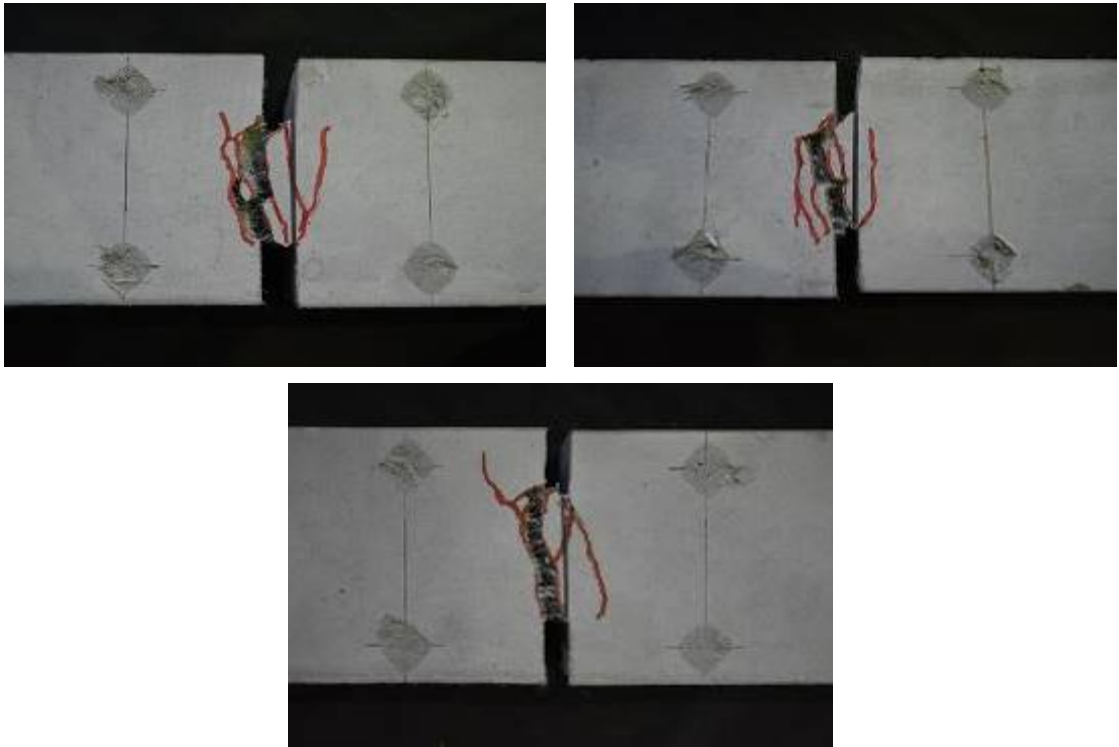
ひび割れ状況（切欠き 2 辺試験体）
